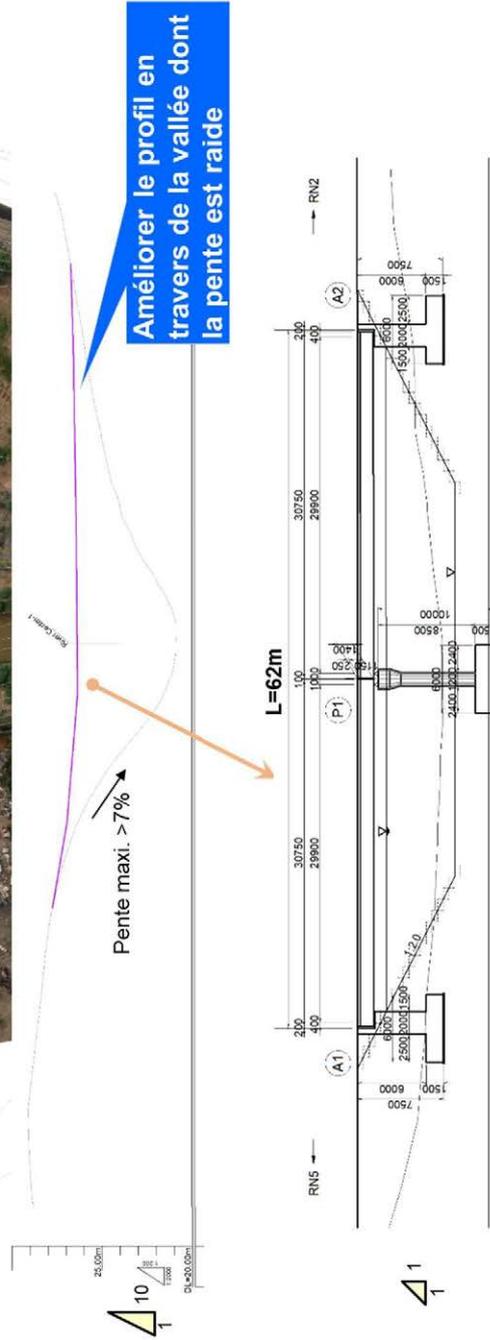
Dessin général du plan des mesures - Route de Nagad
